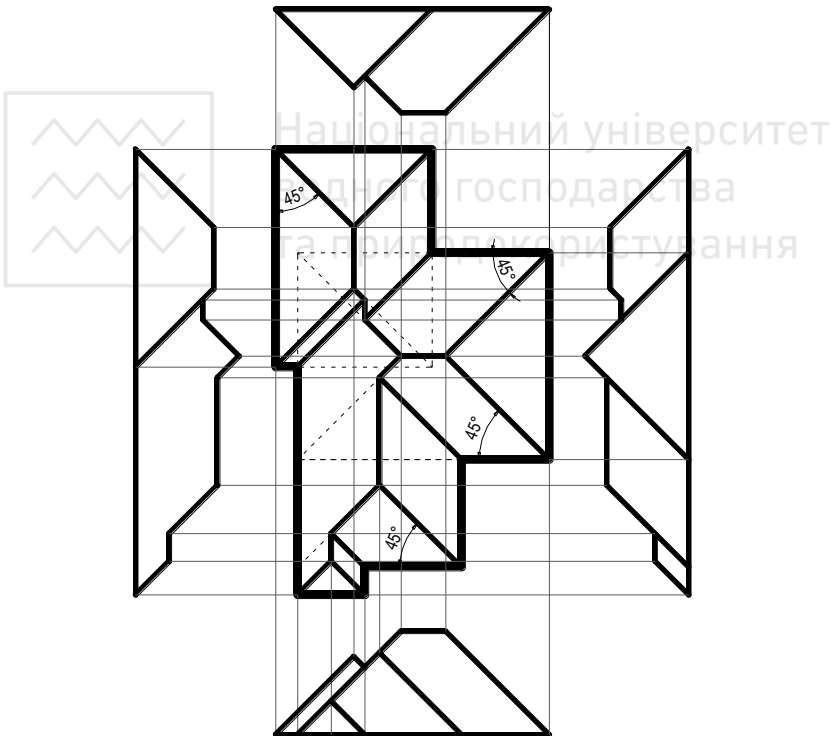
Приклад побудови вальмового даху в плані та його фасадів
